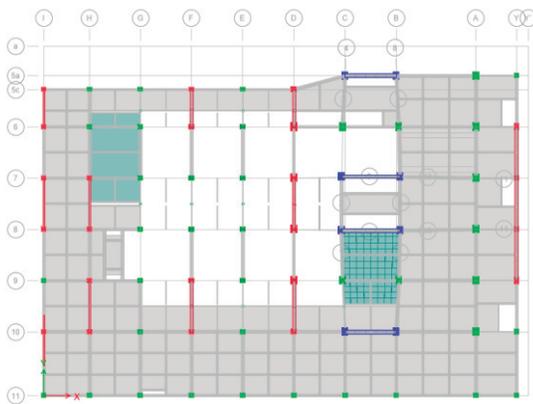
Estructuración de Podio: en color rojo se muestran las paredes de corte en la dirección Y, en color azul las paredes de corte en la dirección X, en color verde las columnas aisladas. En el hueco central quedan contenidas las rampas
